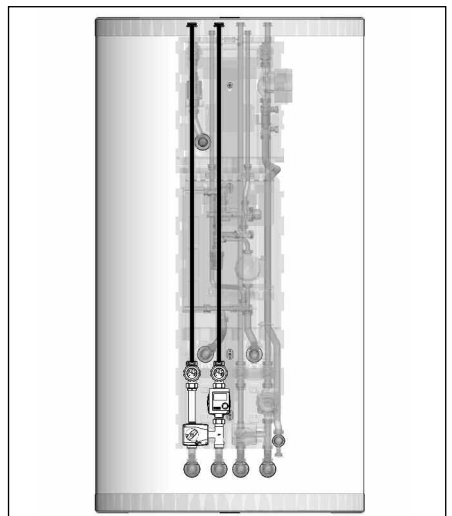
Schema d'installazione per il set d'espansione (Codice n.: 138 35 81)
